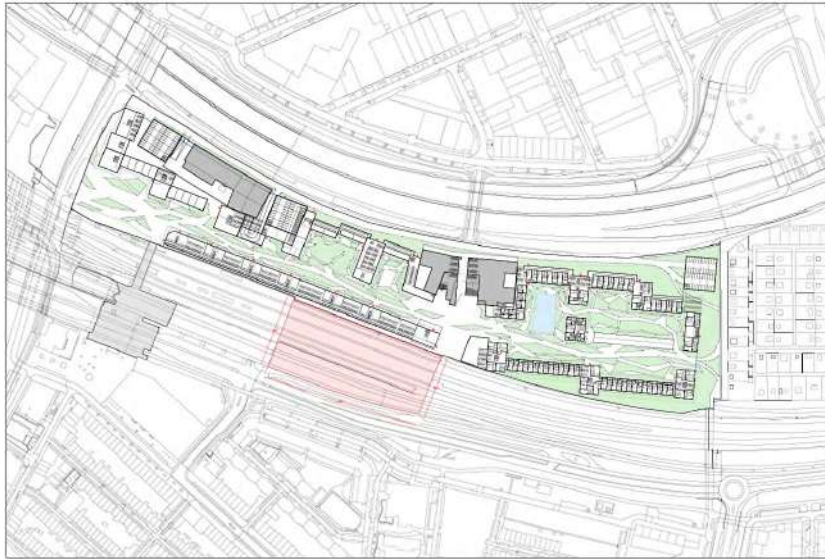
Fietsdoorsteek Boerhaavetunnel (roze vlak aan zuidkant plangebied)
